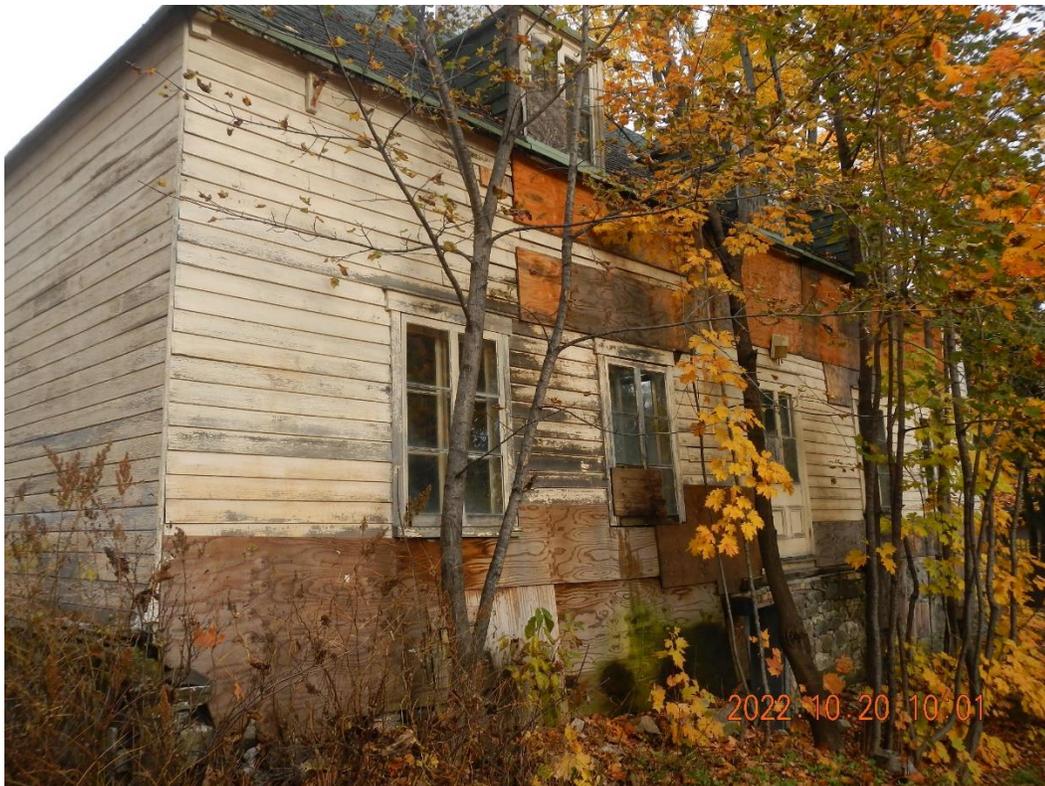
Vue générale du mur sud-est. La fondation du côté gauche est effondrée.
